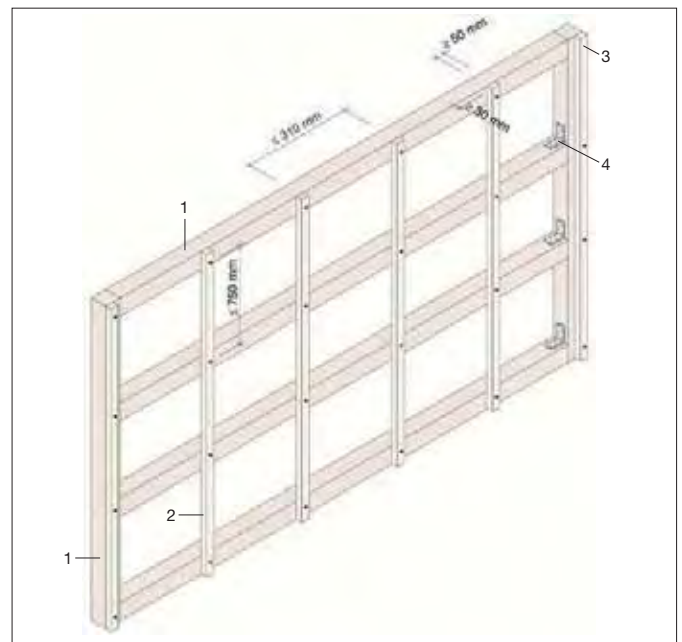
Ejemplo de estructura portante para pared en madera
